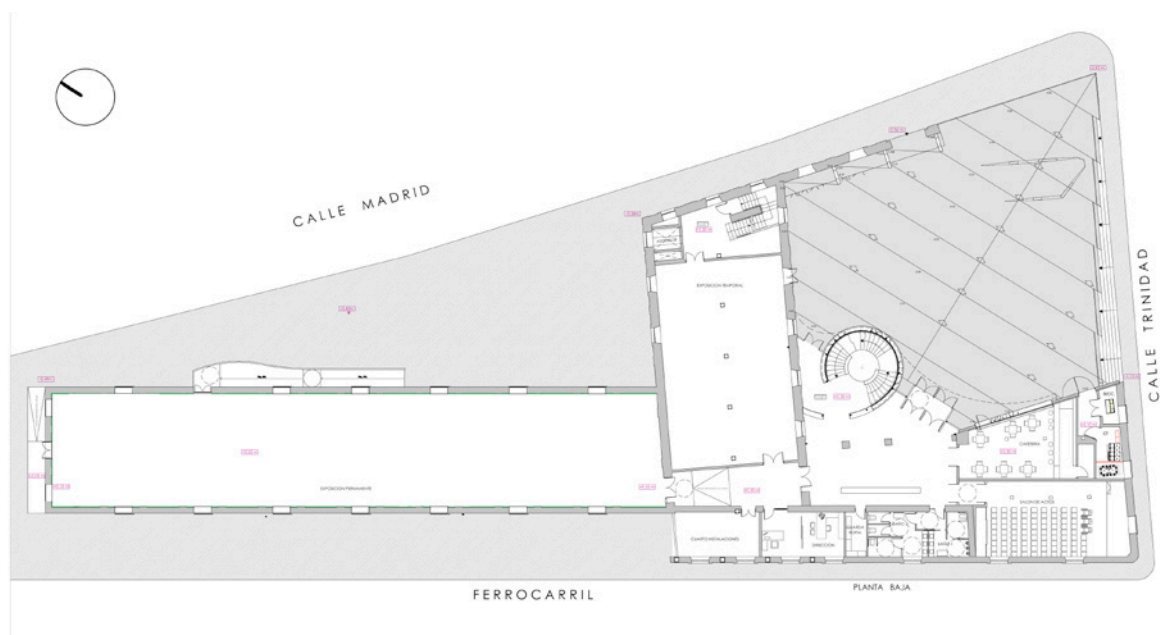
Plano de distribución de la planta baja (Autor: Estudio de Arquitectura Villena S. L.).
